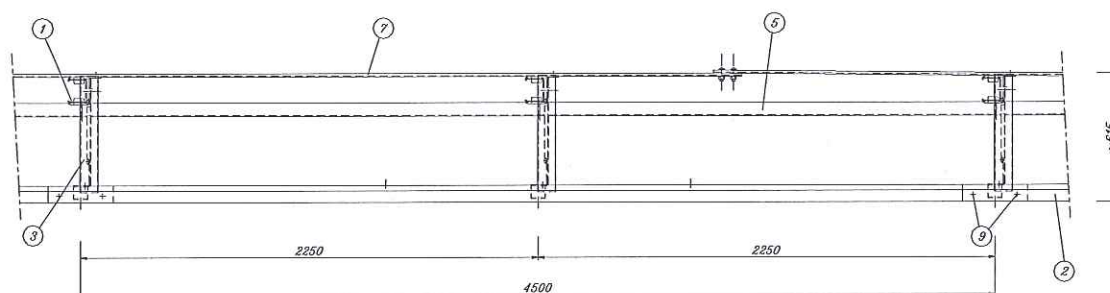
Vista dall'alto della barriera 3NTU-brl.03
